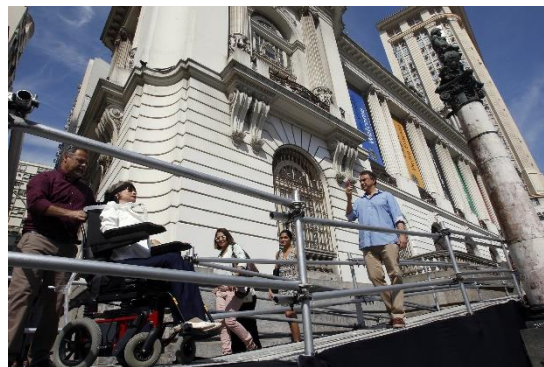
Rampa de acesso na fachada do palácio Pedro Ernesto
